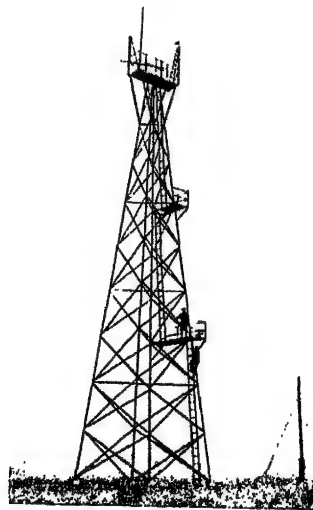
25 m hohe Maste für Windmessungen auf der experimentellen Windkraftanlage in Krim.
